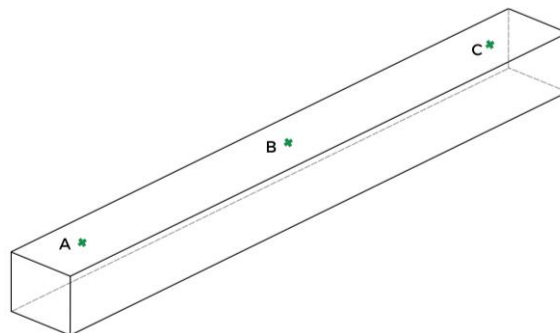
Posición de los puntos a , b y c en las vigas de ensayo.
